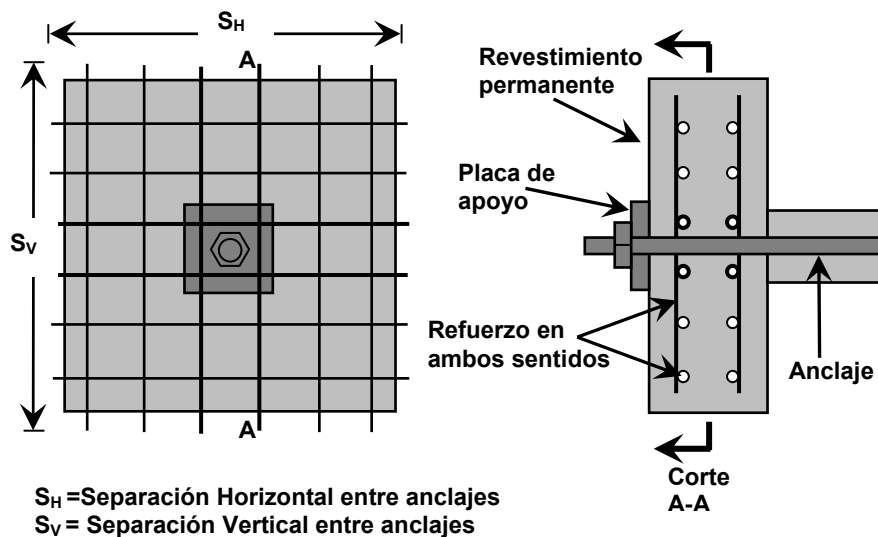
Refuerzo típico de pantalla en un muro anclado.
